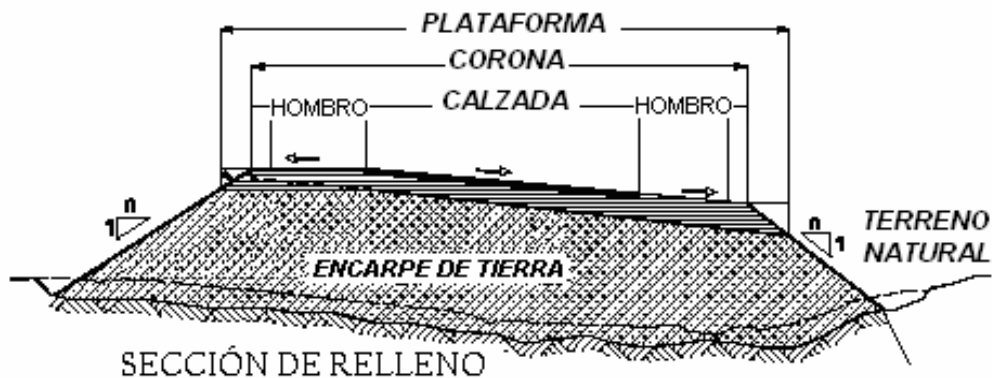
Perfil de la sección transversal en terraplén en curva.
